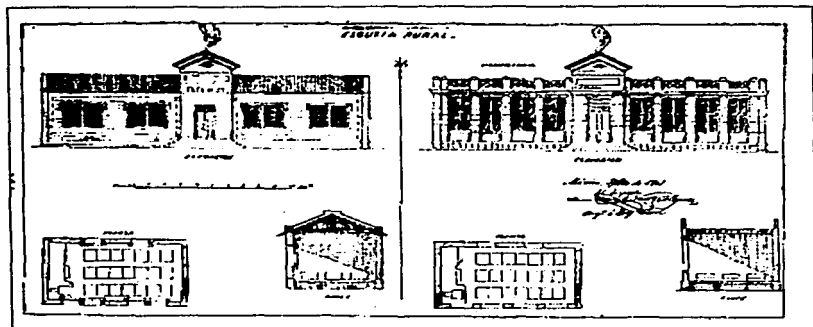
(02) Escuela rural. Fachadas y propuesta para la planta tipo.
